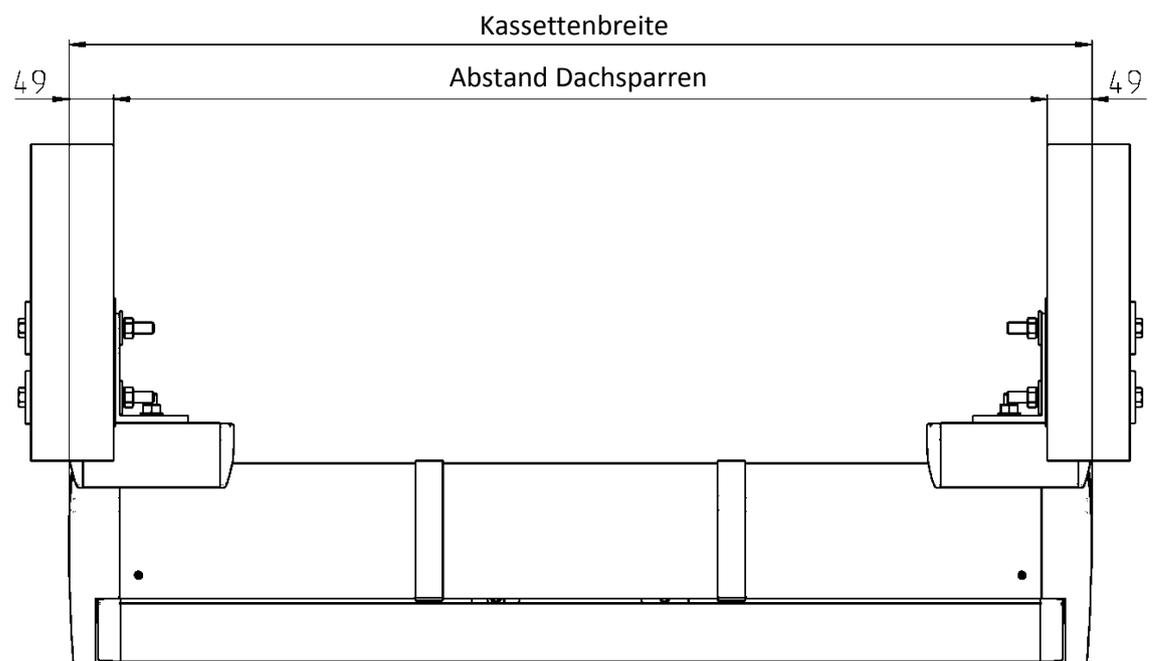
Standard Dachsparrenbefestigung mit Dachsparrenhalter ohne Montageplatte
